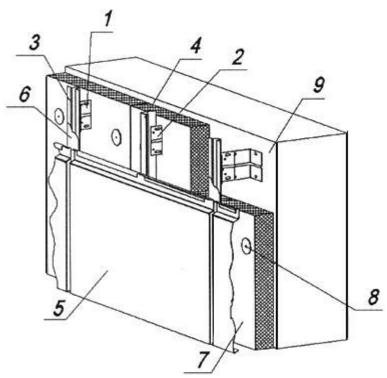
Конструкция НВФС с вертикальной схемой расположения направляющих и облицовкой из фасадных кассет
